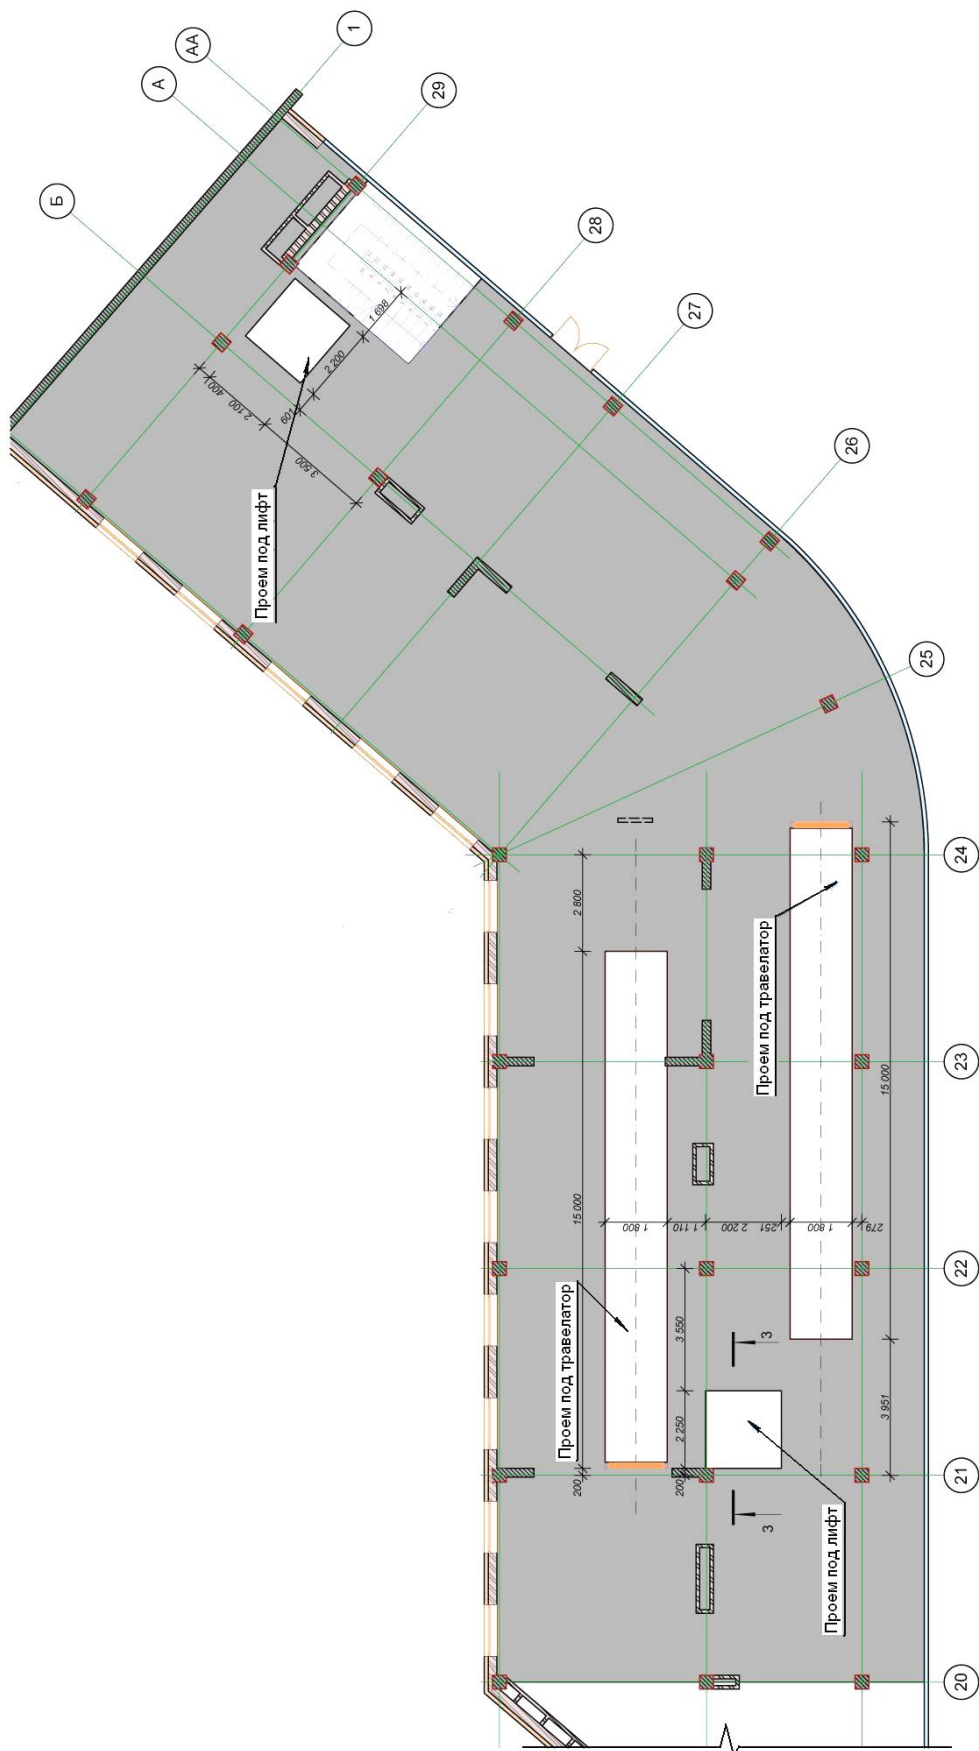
Схема устройства проемов в перекрытии над первым этажом
